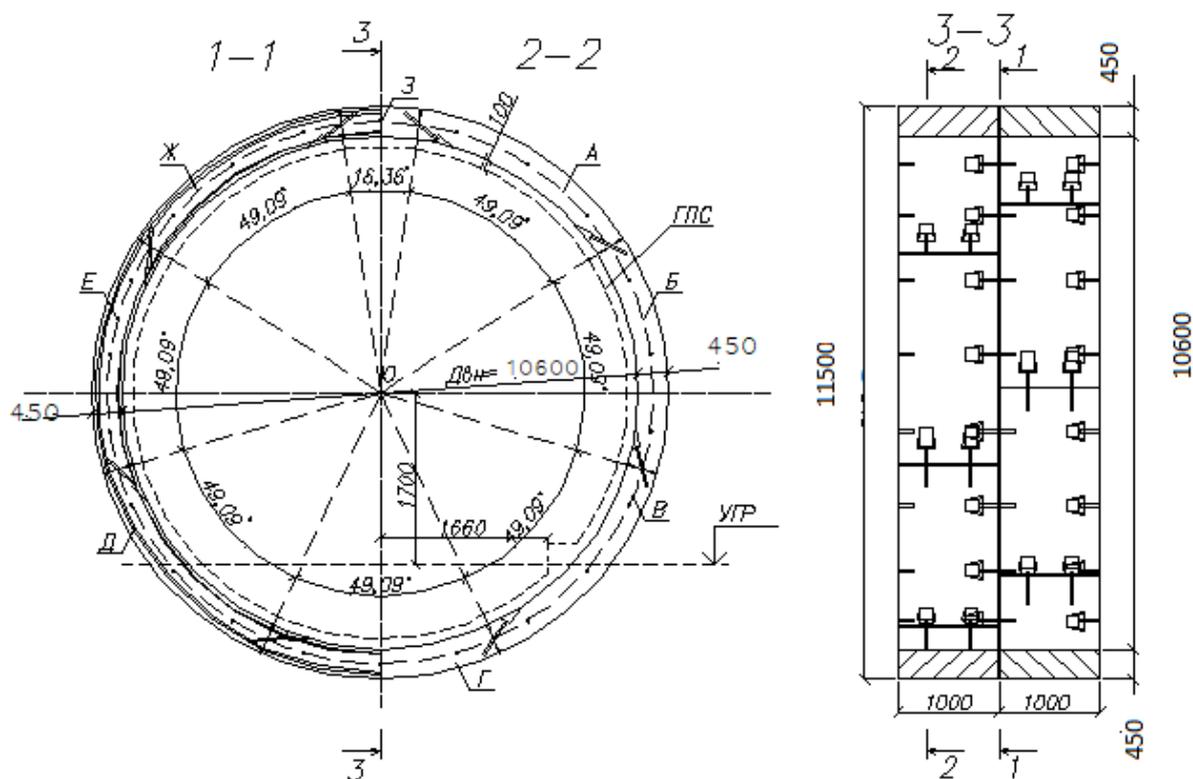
Железобетонная блочная обделка повышенной водонепроницаемости
